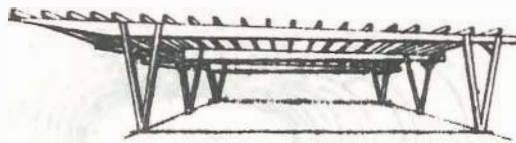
Distintos tipos de elementos estructurales en madera laminada.
